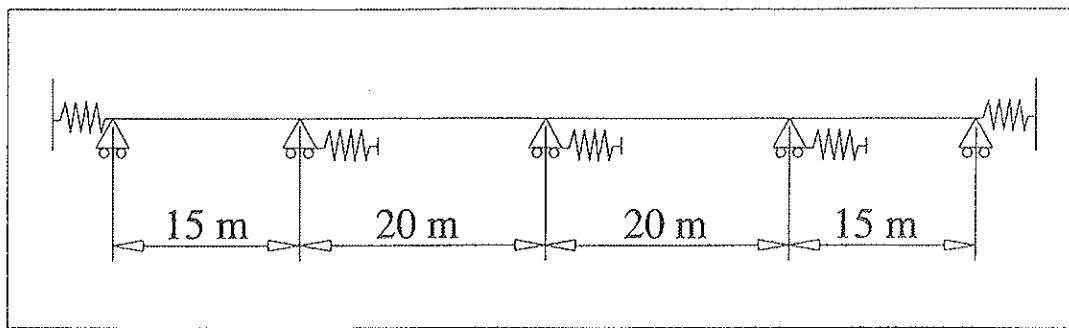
Puente de varios vanos con aparatos de apoyo de neopreno zunchado.
